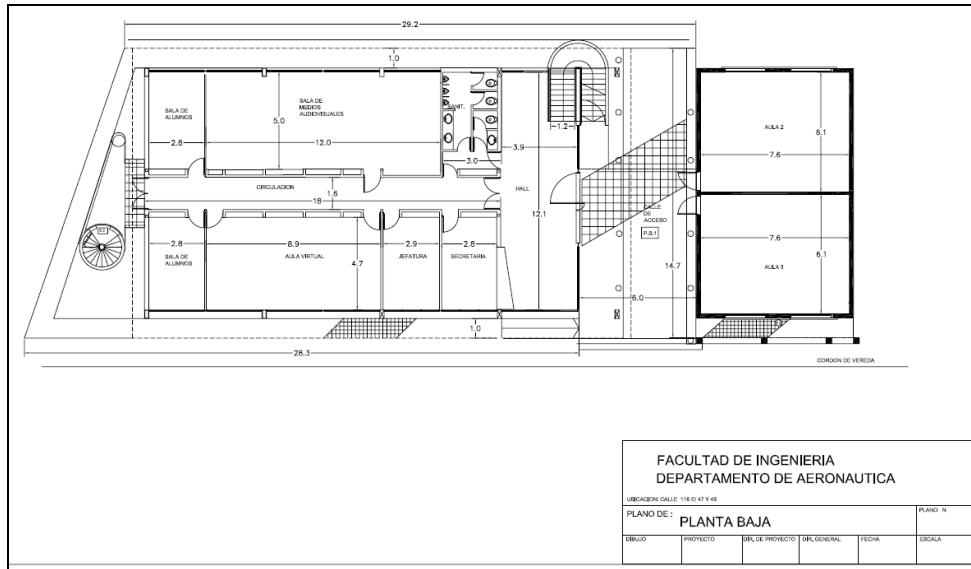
Plano de la planta baja del Edificio Principal
